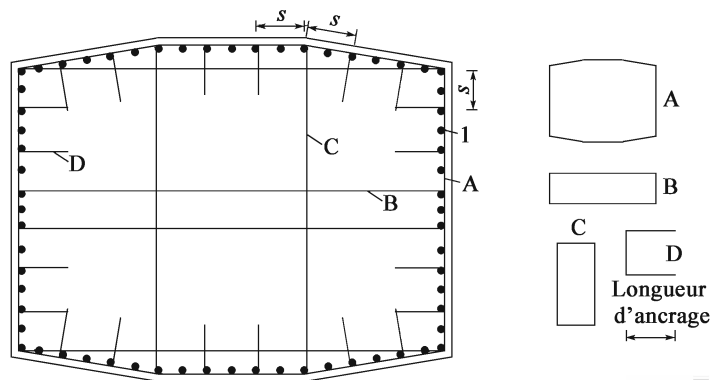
Disposition des cadres multiples et des étriers, dans un poteau
